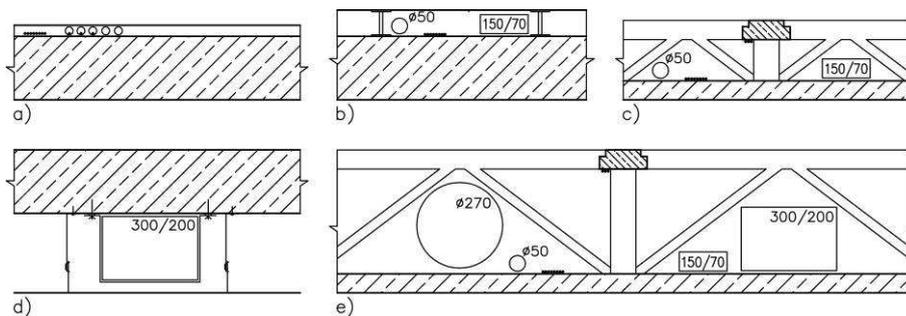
Deckenaufbauten bei unterschiedlichen Installationsleitungs- Systemen
